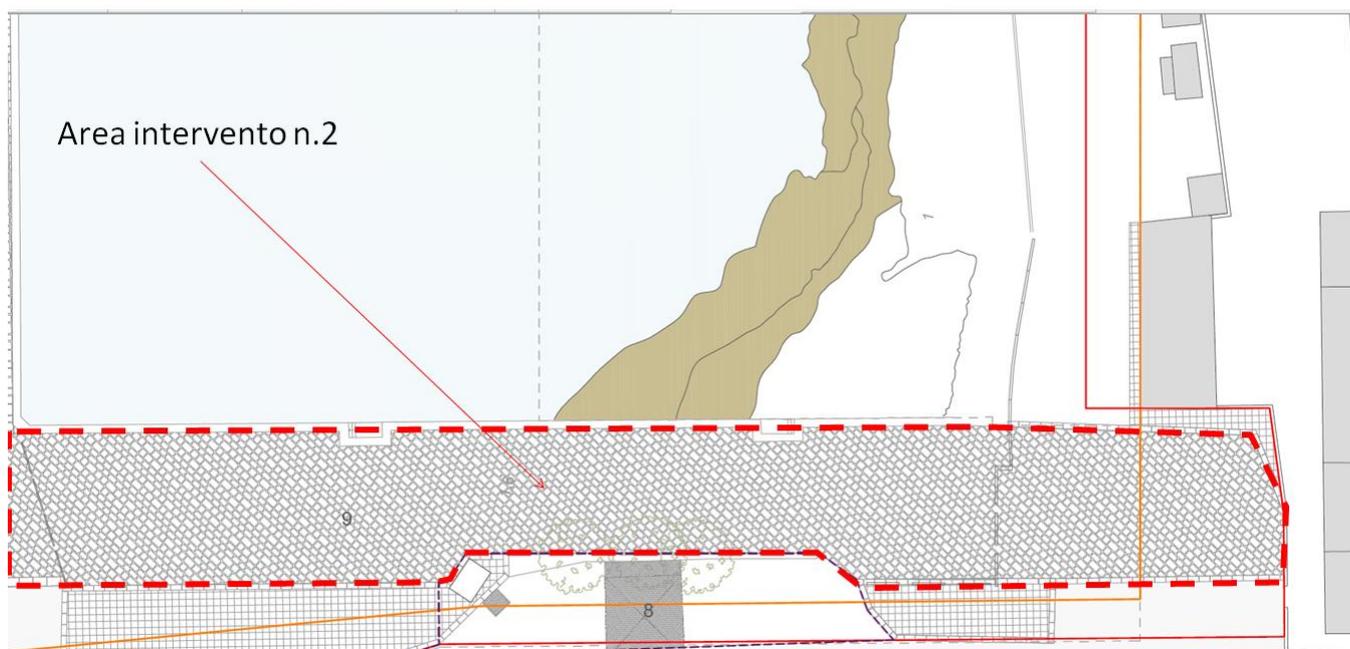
Stralcio planimetrico dell'area in cui sono previsti gli interventi di ripavimentazione della banchina
